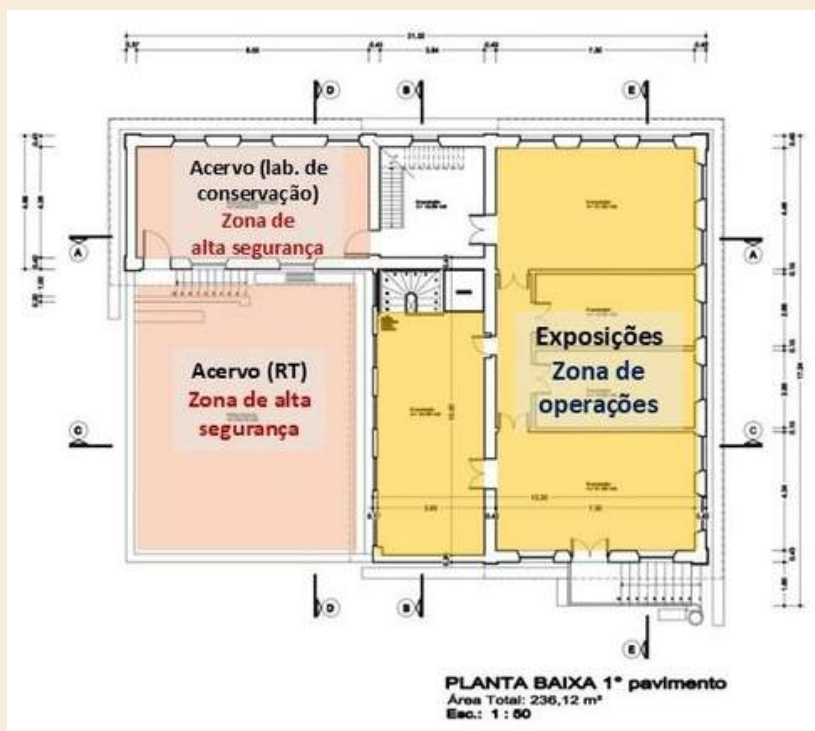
Planta baixa do 1º pavimento do Museu Joaquim Felizardo
